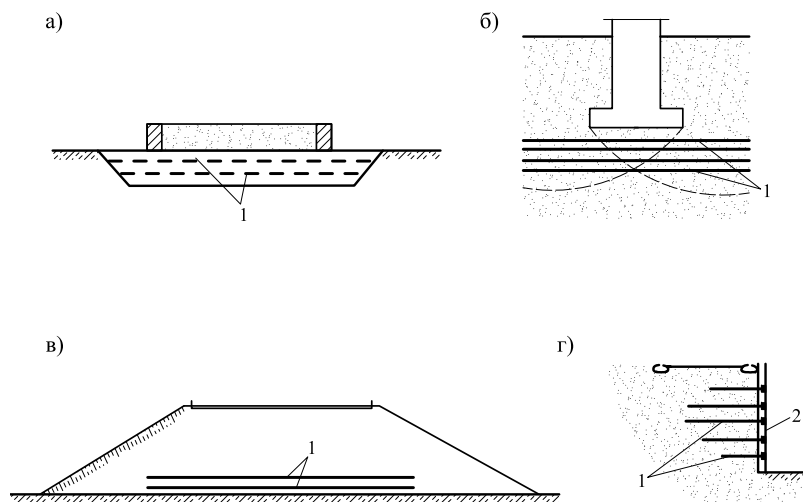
Схеми підсилення основ горизонтально розташованими армувальними елементами: а – під резервуаром; б – під фундаментами будинку; в
